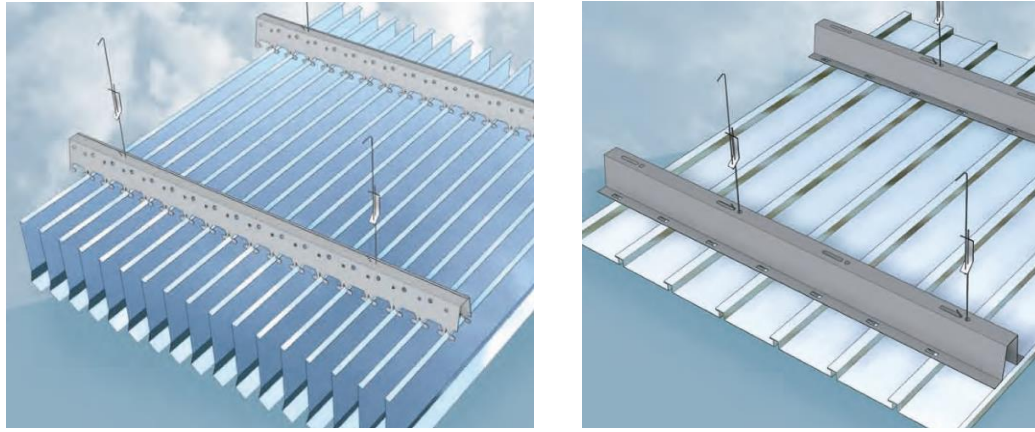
Posición de lamas descolgadas (izquierda) o enrasadas (derecha). Fuente: www.knauf.es
